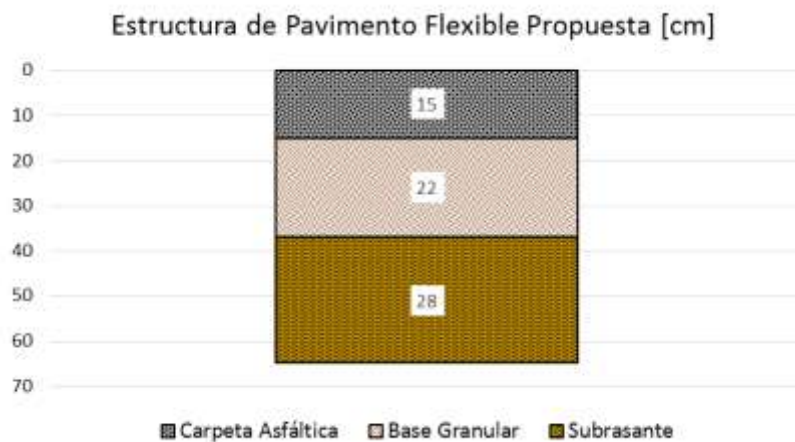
Estructura de Pavimento Flexible Propuesta
